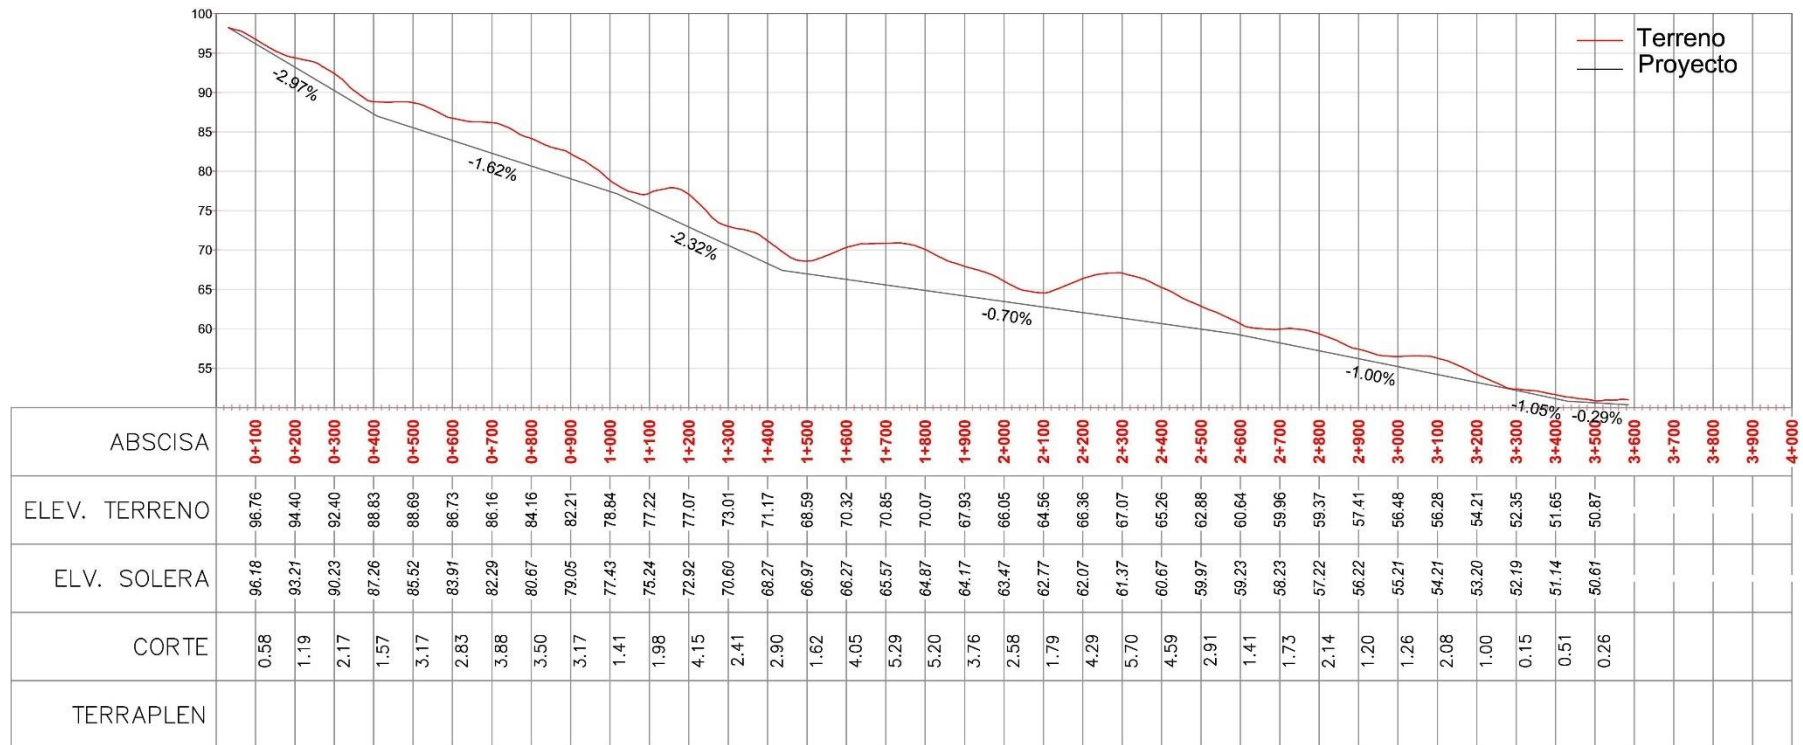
Perfil del cauce y perfil de solera de la propuesta para el Ingreso 2
